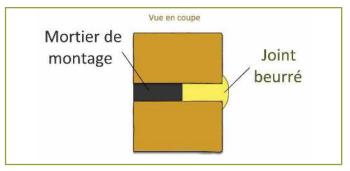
Schéma en coupe d'un joint beurré (Dessin de Cédric Houel)
